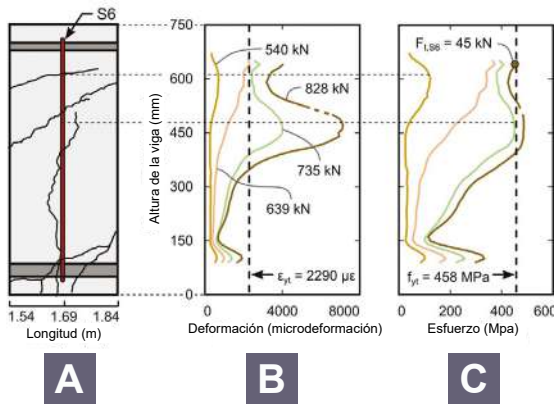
Demanda del estribo JP-2 S6: (a) patrón de agrietamiento en la ubicación JP-2 S6; (b) deformaciones DFOS; y (c) esfuerzos de refuerzo.
